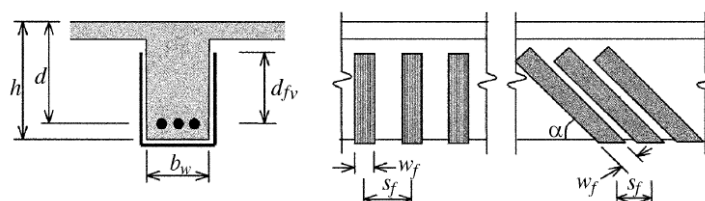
Parâmetros dimensionais utilizados no cálculo do reforço ao corte (ACI 440.2R-08, 2008).
